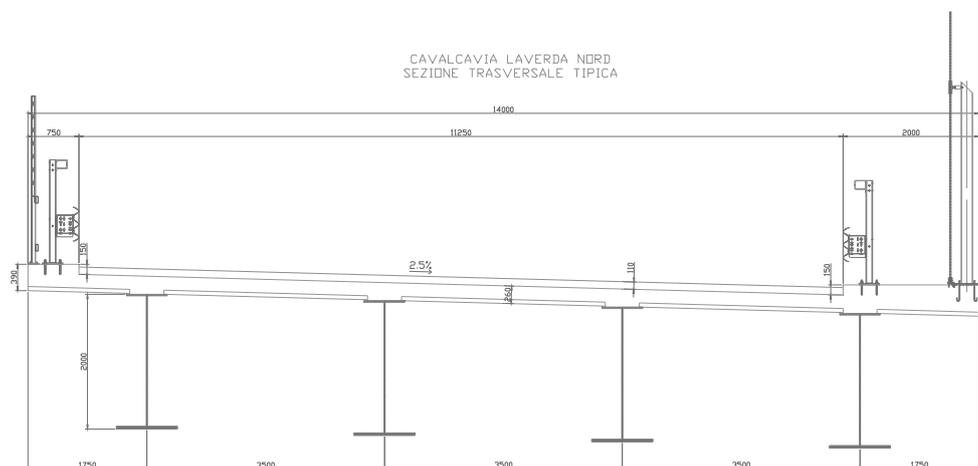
Sezione trasversale Ponte Torrente Laverda asse Nord
